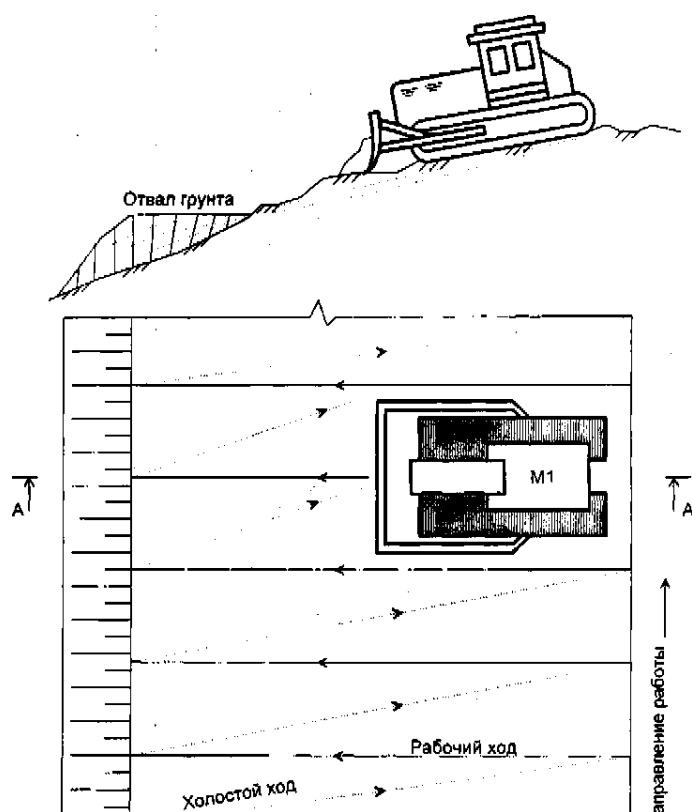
Планировка строительной полосы при поперечном уклоне[30]
